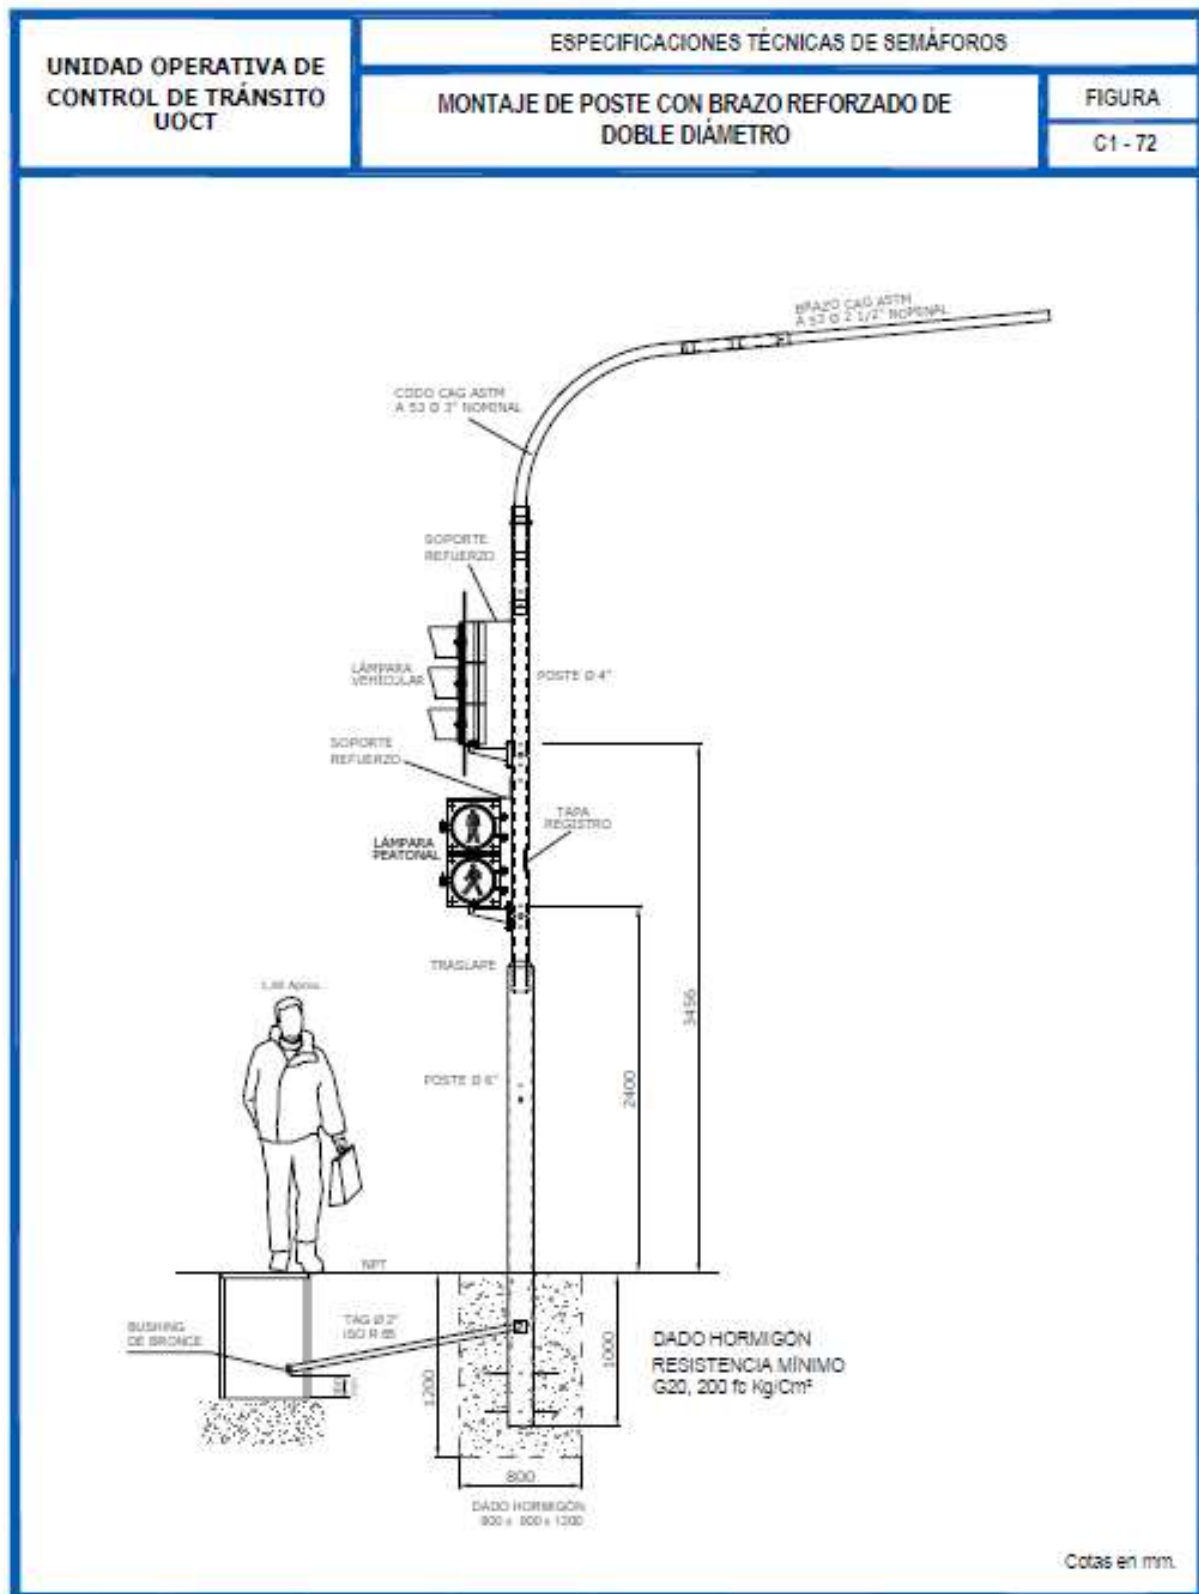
72 Montaje Poste con Brazo Reforzado de Doble Diámetro
